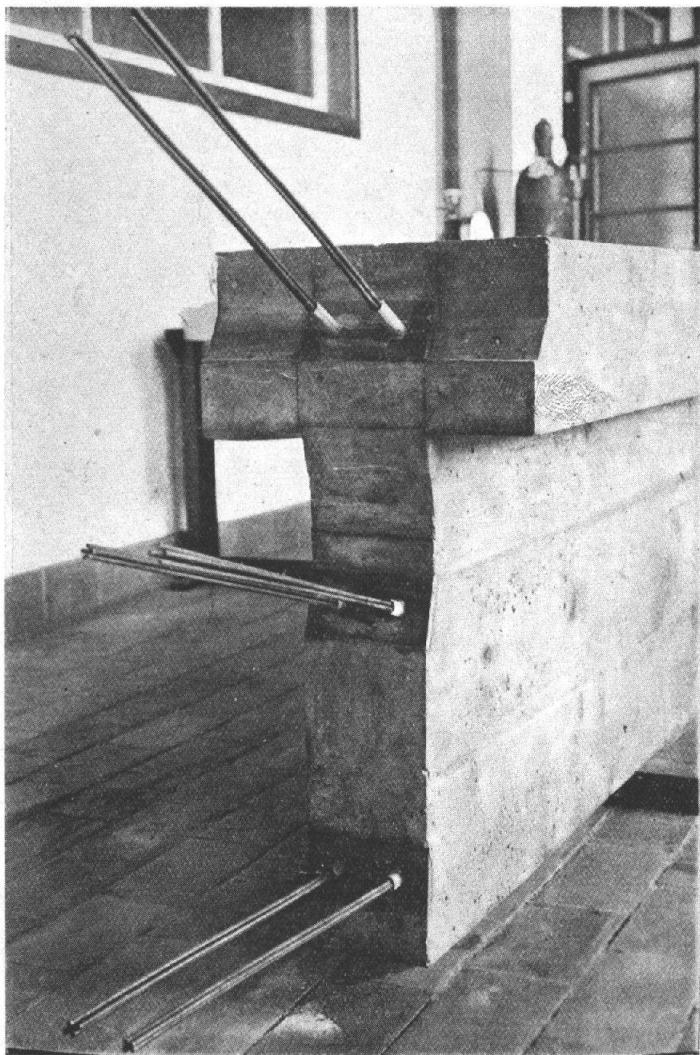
About d'une poutre en béton précontraint avant ancrage des armatures.
